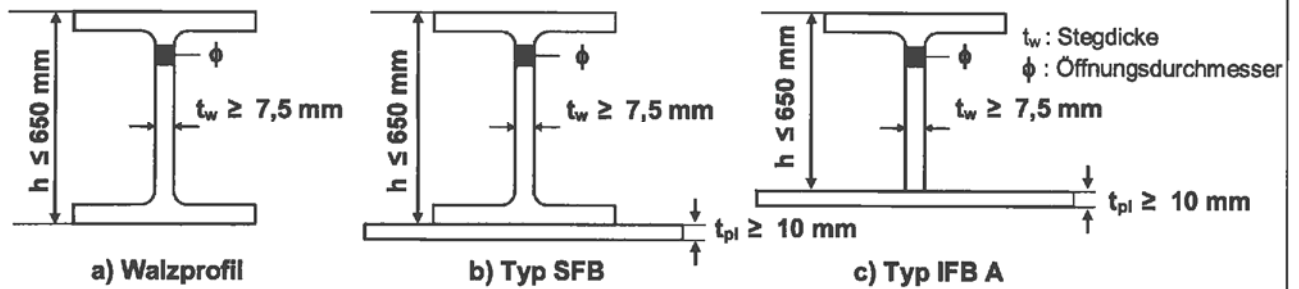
Zulässige Querschnittsformen der Stahlträger
